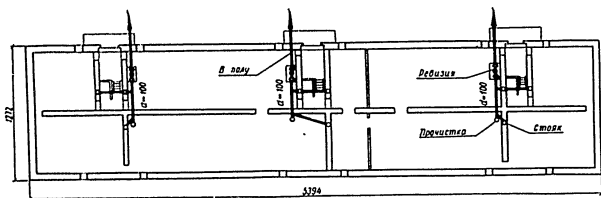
План технического подполья жилого дома с фронтальными выпусками канализации.
